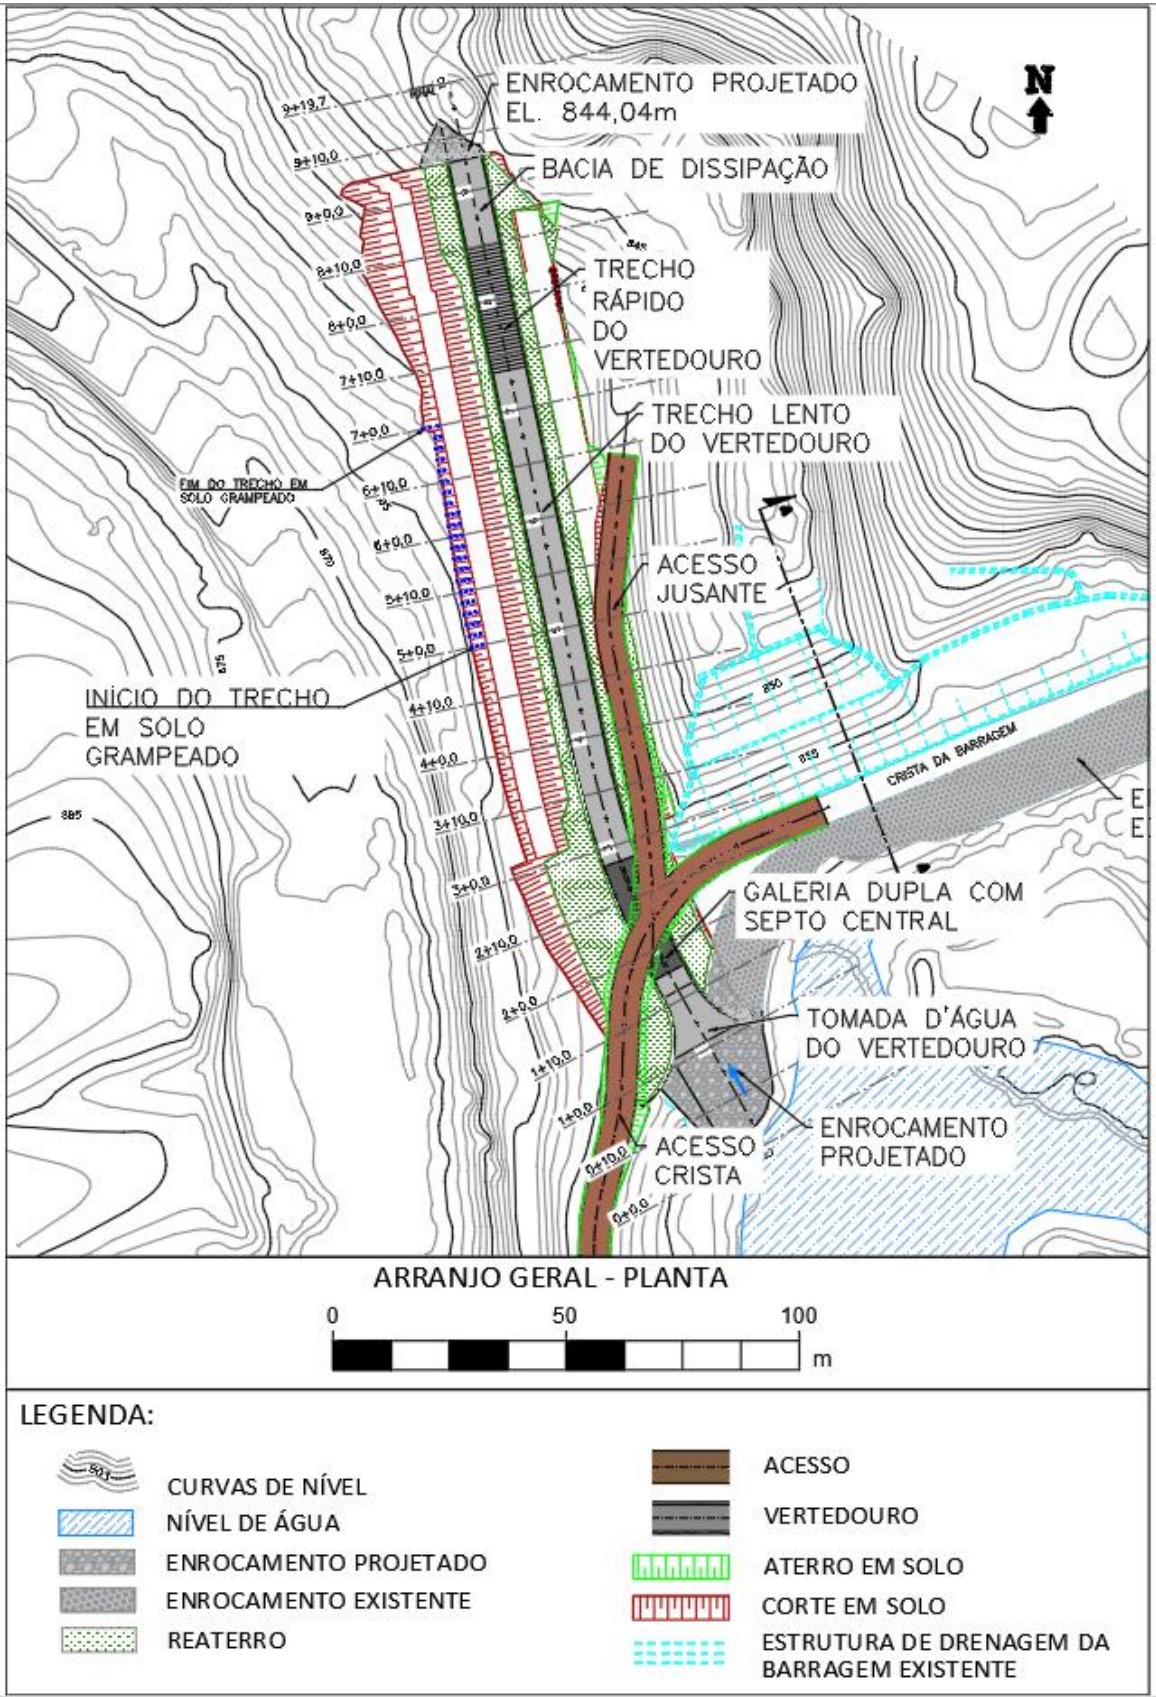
Arranjo Geral da Planta do Vertedouro de Soleira Livre da Barragem do Quinzinho.
